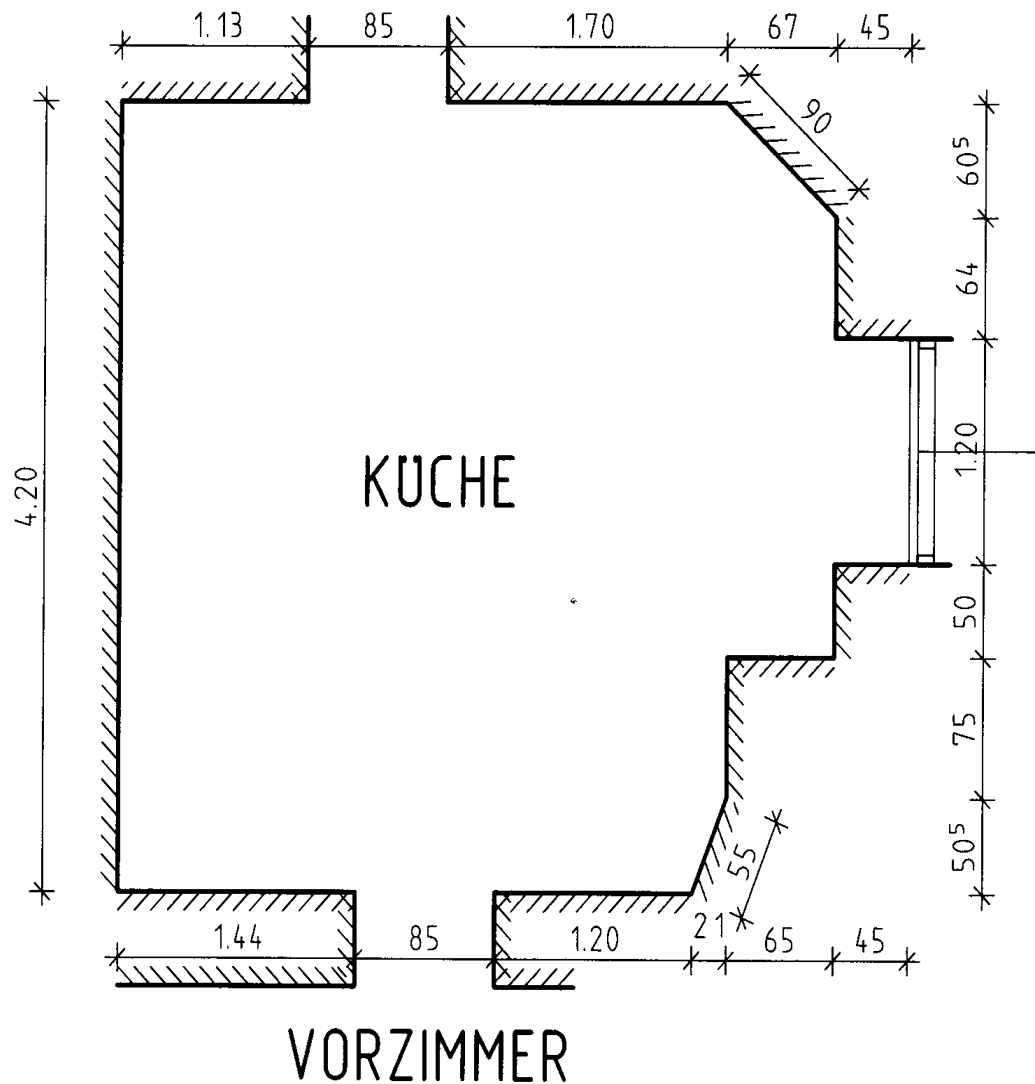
Grundriss Küche - Fallbeispiel 4
